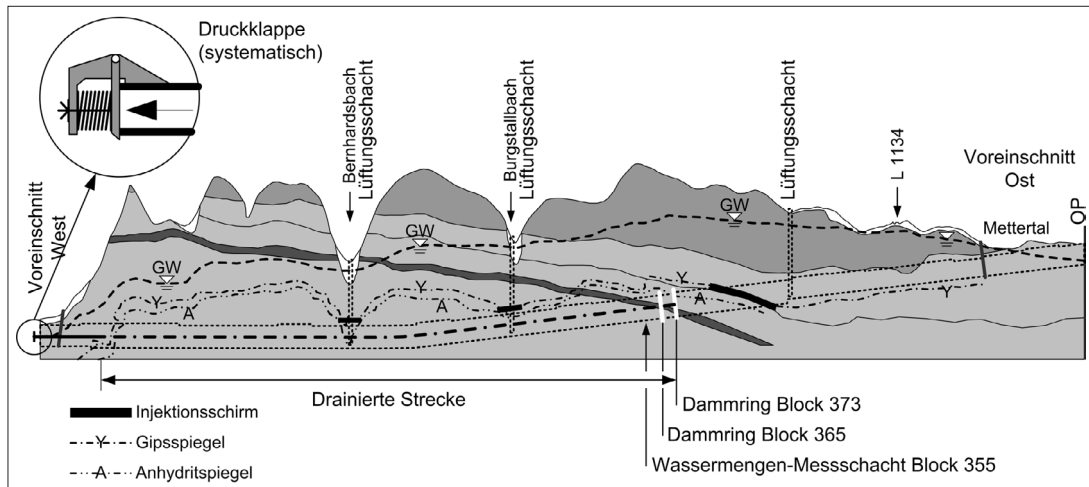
Druckhaltendes Drainagesystem mit Druckklappe, ausgeführt im Freudenstein-Tunnel [13]
